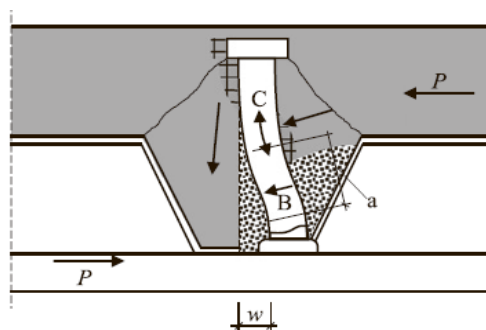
Модель Лунгерсхаузена для описания НДС стержневого анкерного упора в составе сталежелезобетонного перекрытия с плитой, устроенной по несъемной опалубке из стального профилированного настила [132]
